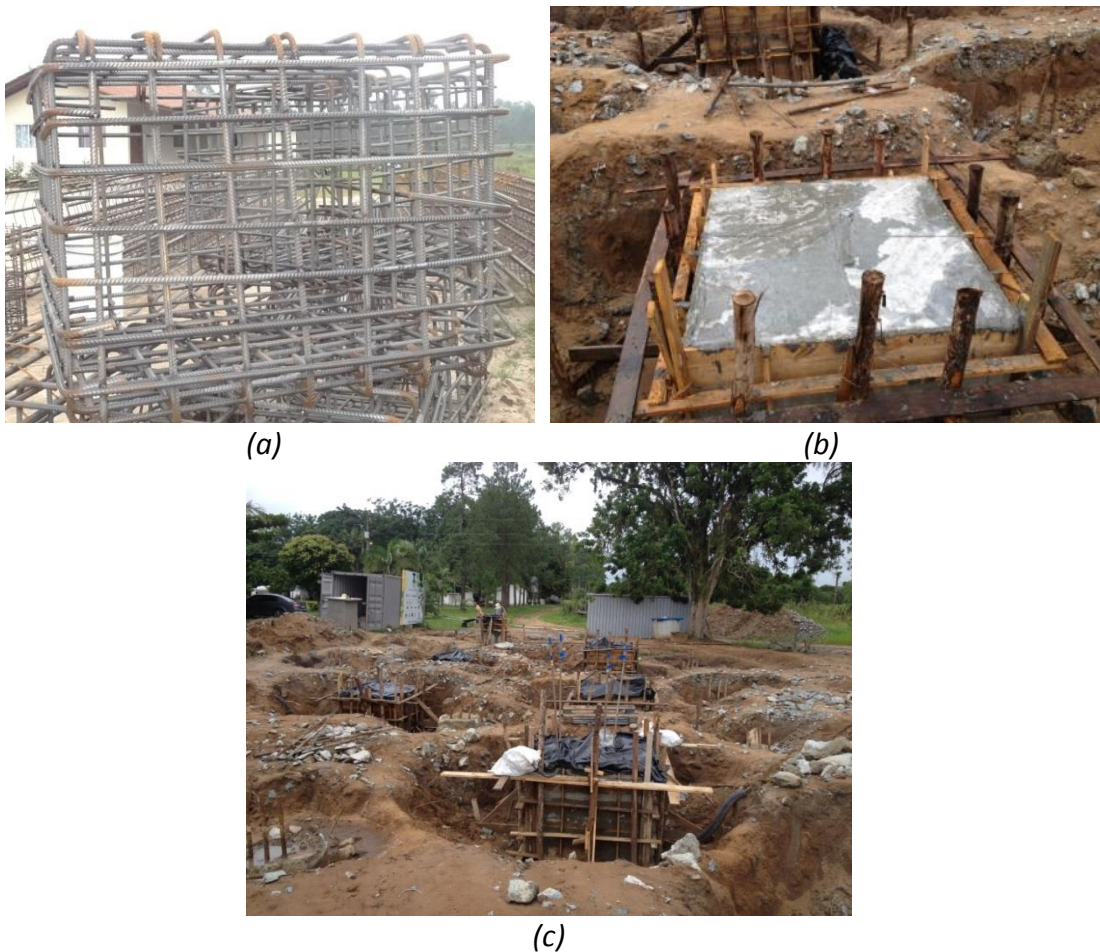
21 - Detalhe do bloco de coroamento a) armadura b) e c) executado
